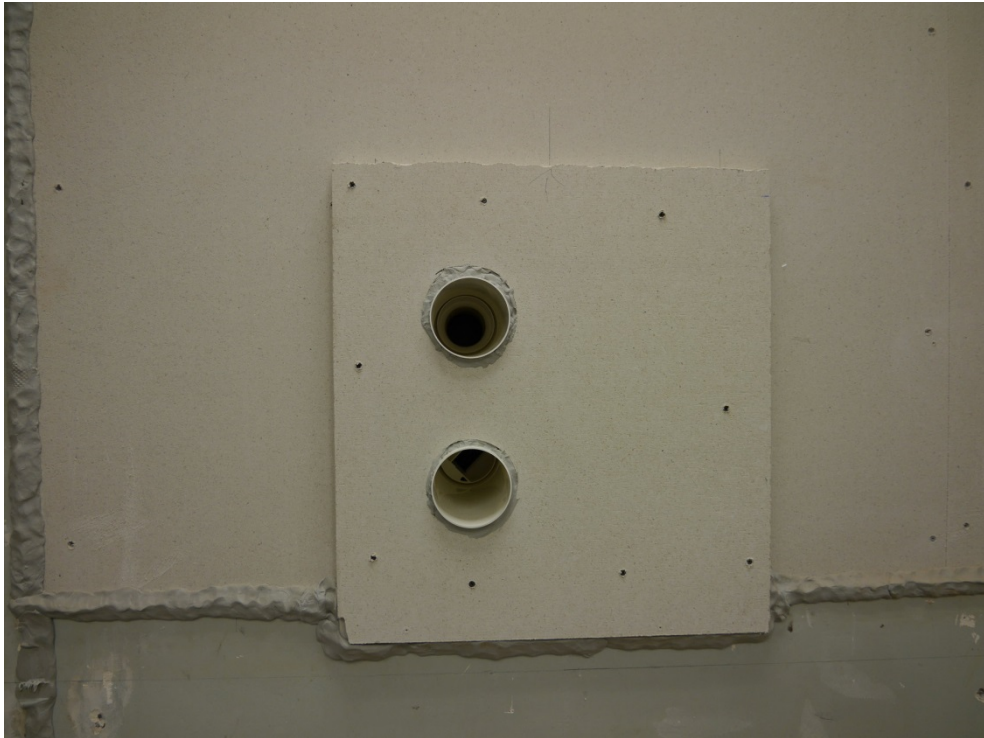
Lüftungsöffnungen außenseitig (Außenluft oben, Fortluft unten), Fassadenabschluss Edelstahlschote noch nicht montiert.
